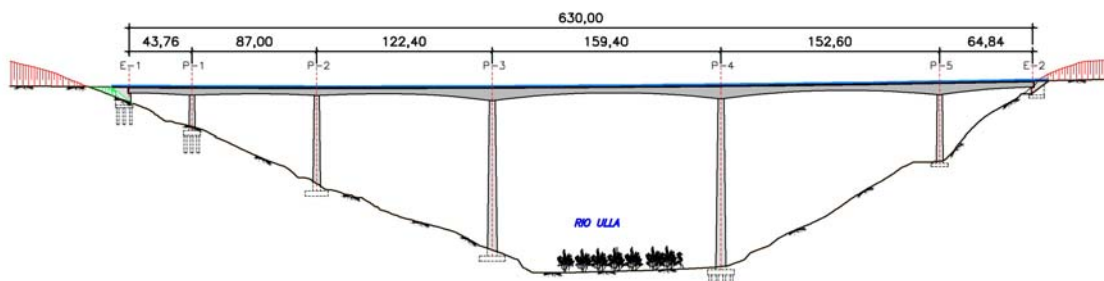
Alternativa de voladizos sucesivos con 159,4 m de luz central
